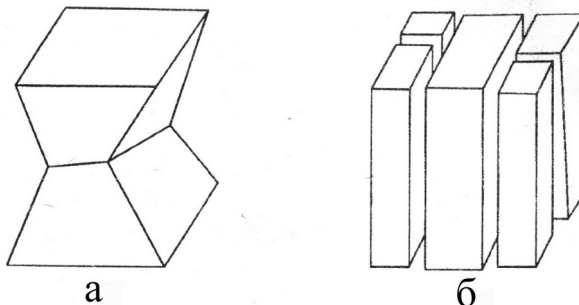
Схема разрушения цементного кубика: а – без смазки торцов; б – со смазкой торцов
